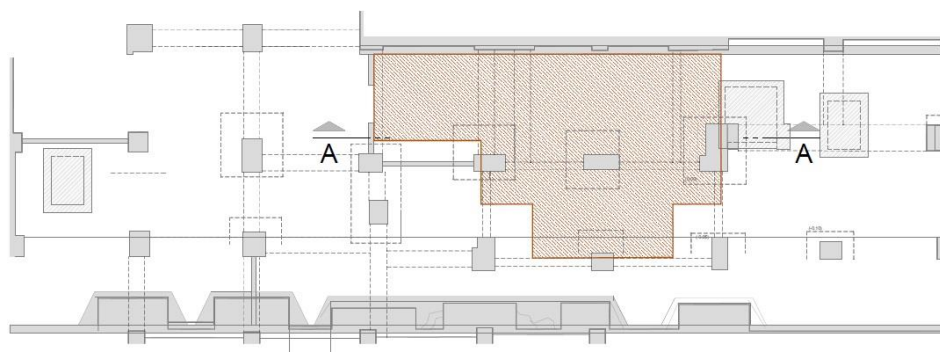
Planta do piso 0 com identificação da área afeta à demolição
